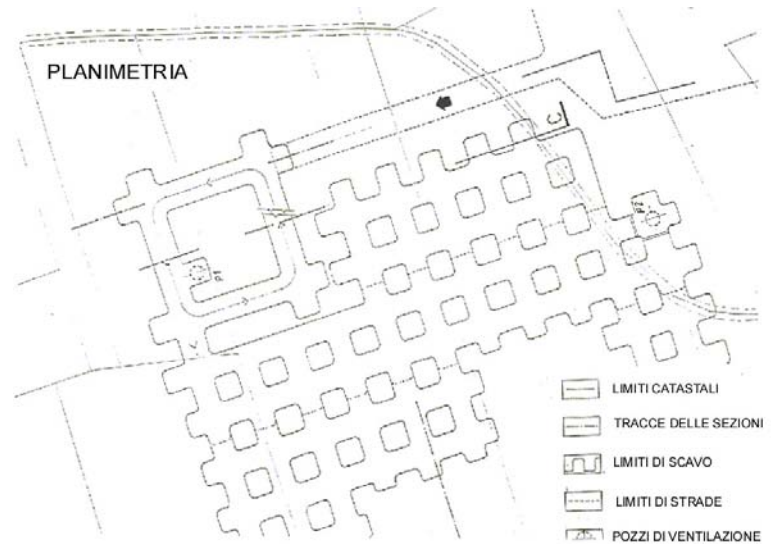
planimetria di una coltivazione a camere e pilastri sistematici, con rampa d'accesso di forma quadrata (scavo convenzionale) e pozzetti di ventilazione
